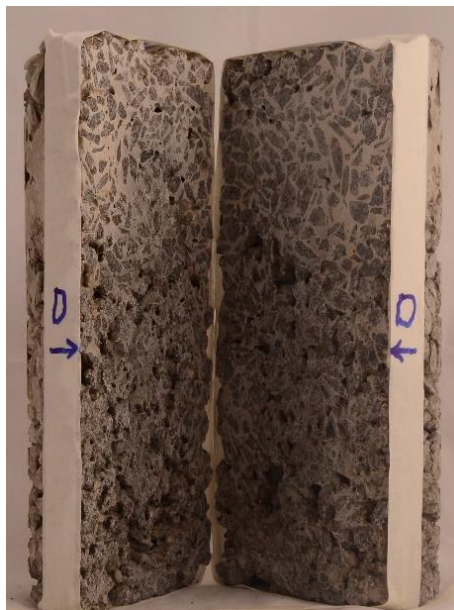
Plano de corte do corpo de prova na horizontal
